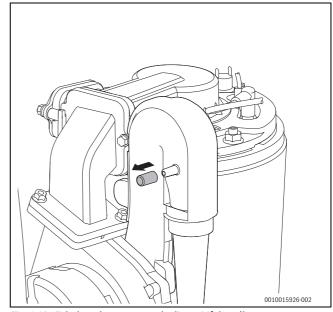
Tubulure de mesure sur le dispositif de mélange
